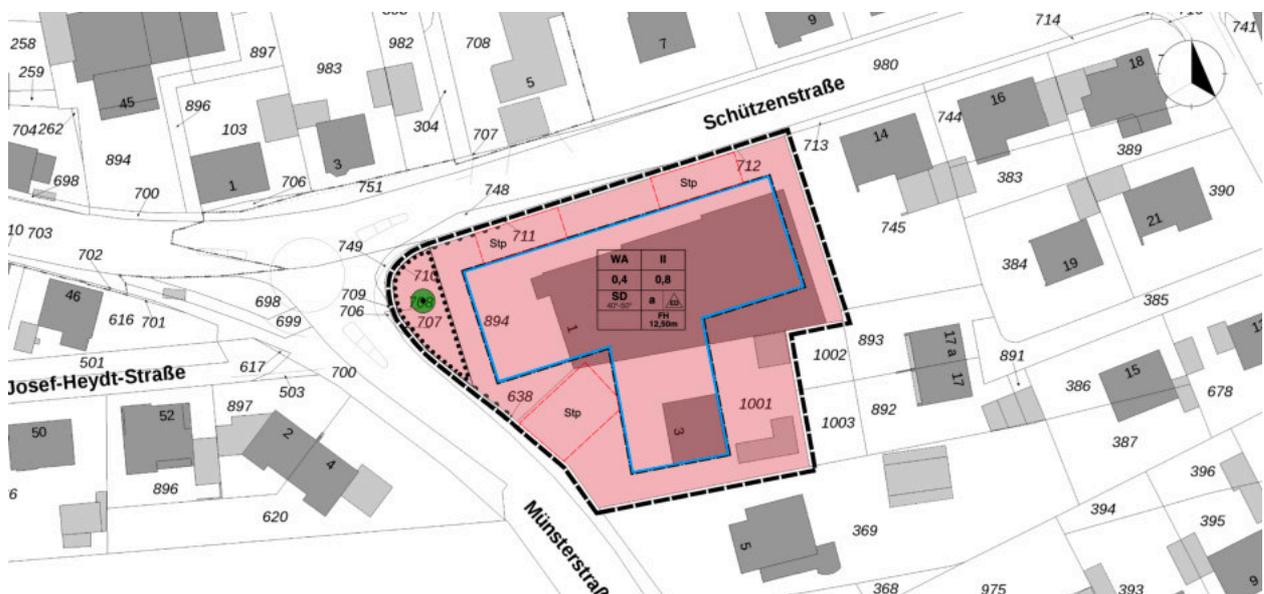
4. Änderung des Bebauungsplans "Beekenkamp" (scheuvens + wachten plus, 2019)
